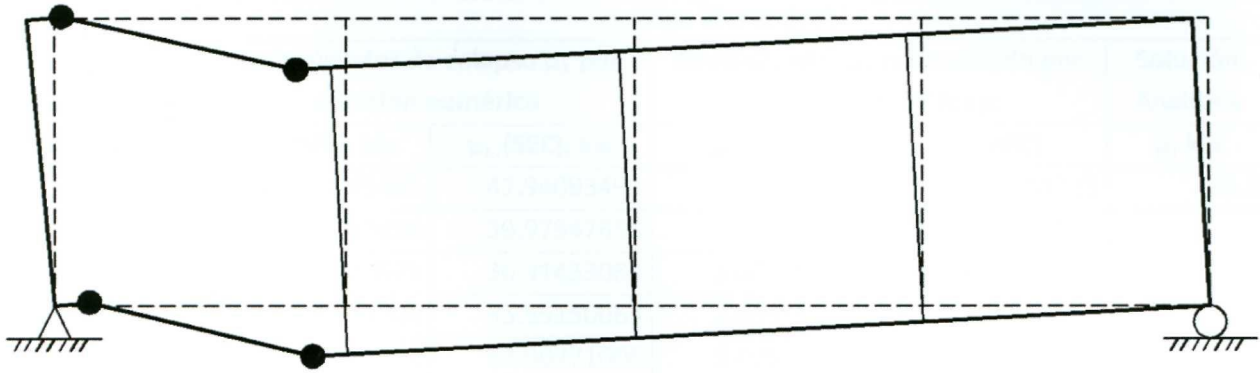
Mecanismo de colapso de viga Vierendeel, con geometría original sobreimpuesta.¹⁴⁰
